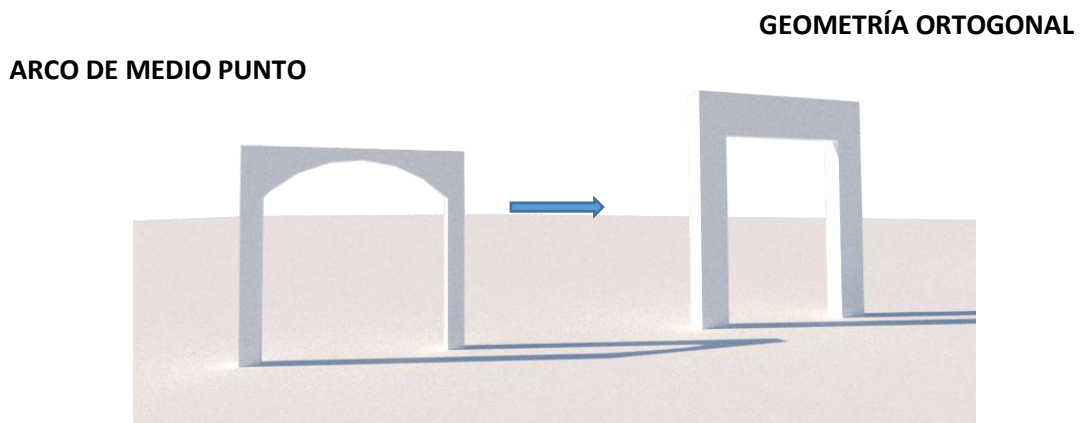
, proceso de diseño conjunto arquitectónico. Fuente: elaboración propia.
